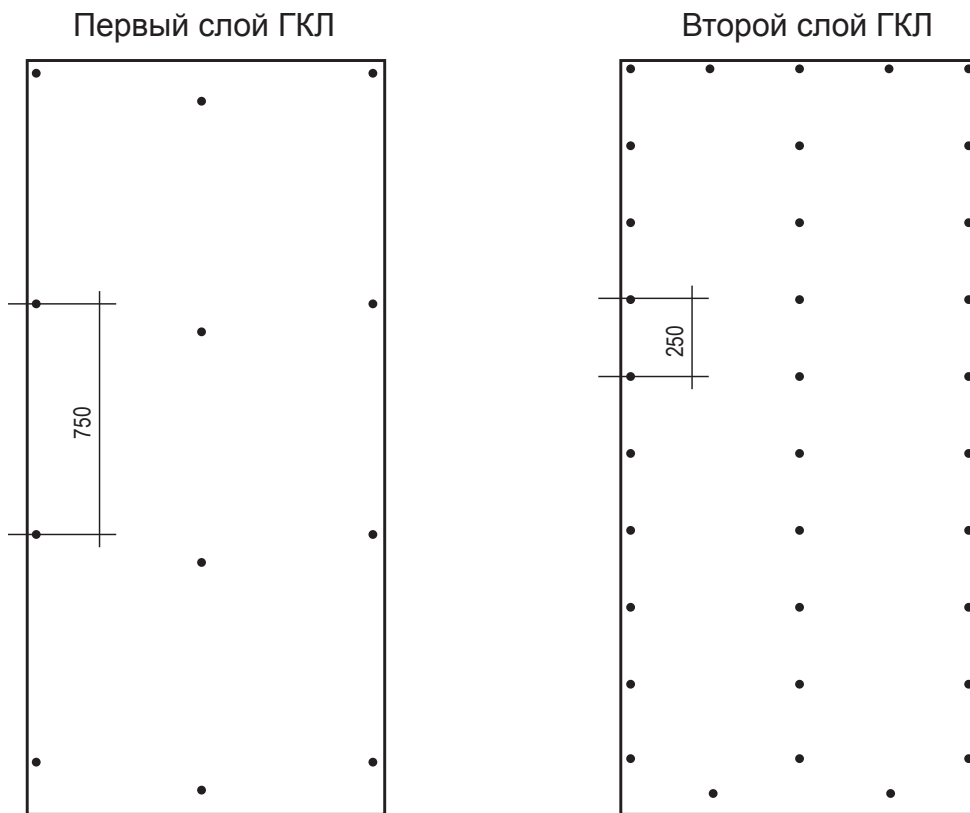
Схема расположения шурупов при двухслойной облицовке ГКЛ
